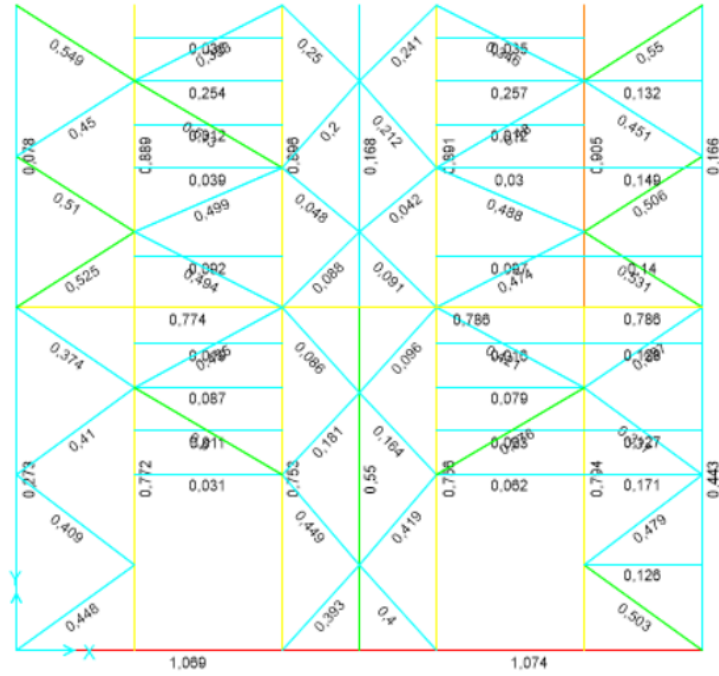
Factores de utilización vista en planta elevación 12 m.
